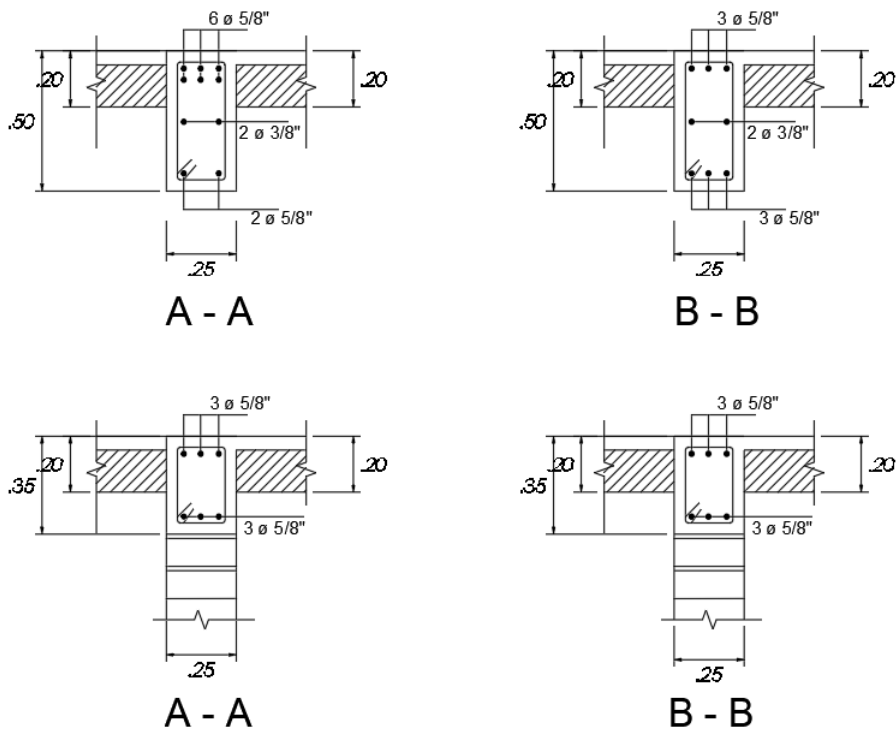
Detalle de vigas existentes, bloque 2 del pabellón A - I.E. N°40092
